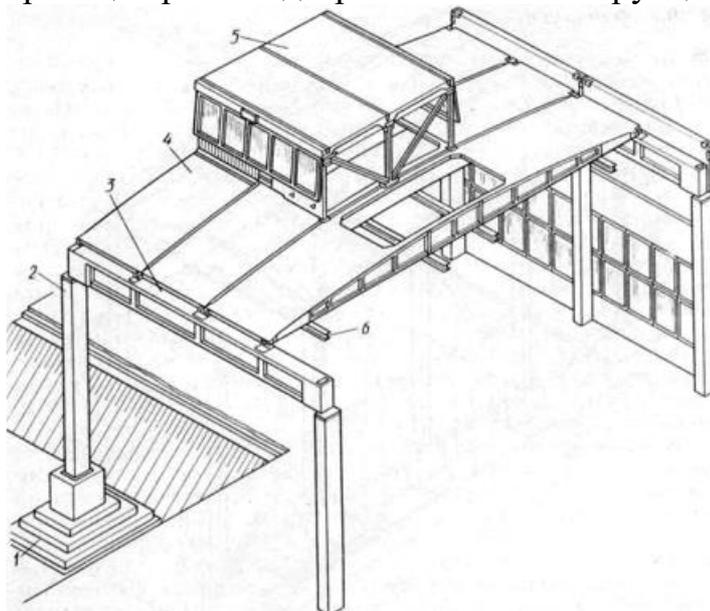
Железобетонный каркас со стропильными балками
